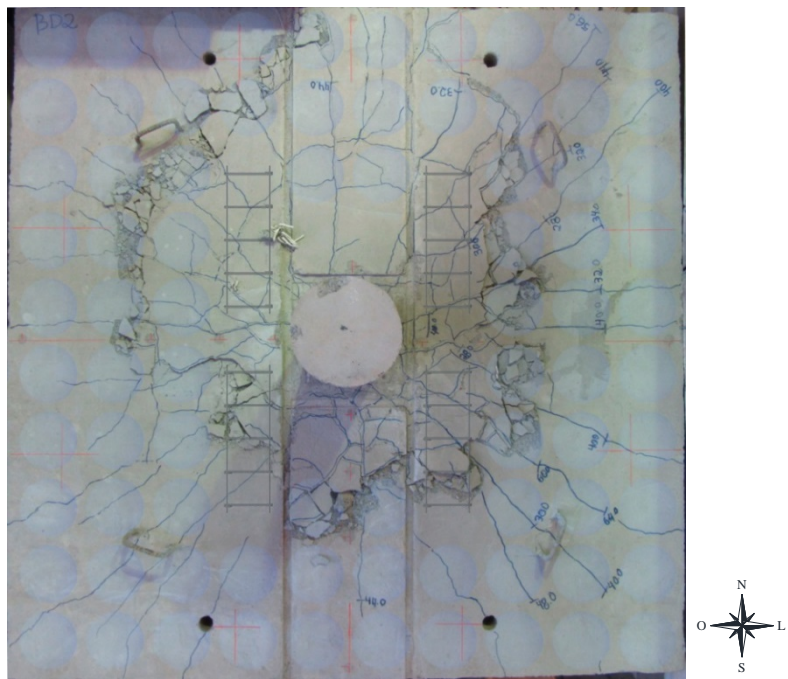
Mapa de fissuração (laje BD2)
